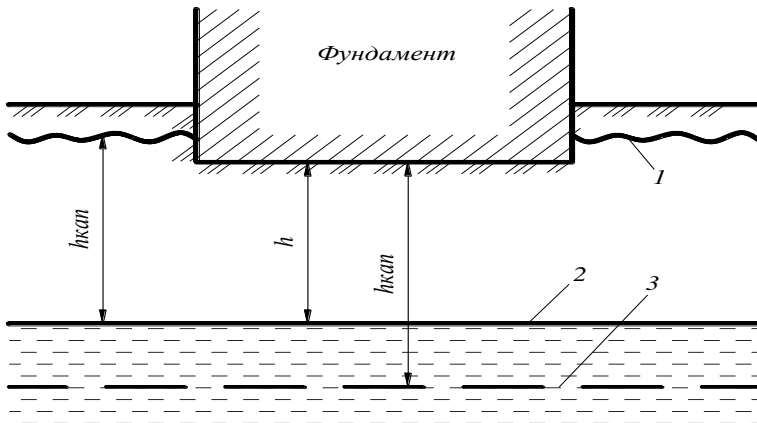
Зміна капілярного тиску на основу фундаменту при пониженні рівня ґрунтових вод: 1 – рівень капілярного підняття; 2 – початковий рівень ґрунтових вод; 3 – рівень ґрунтових вод, що опустився
